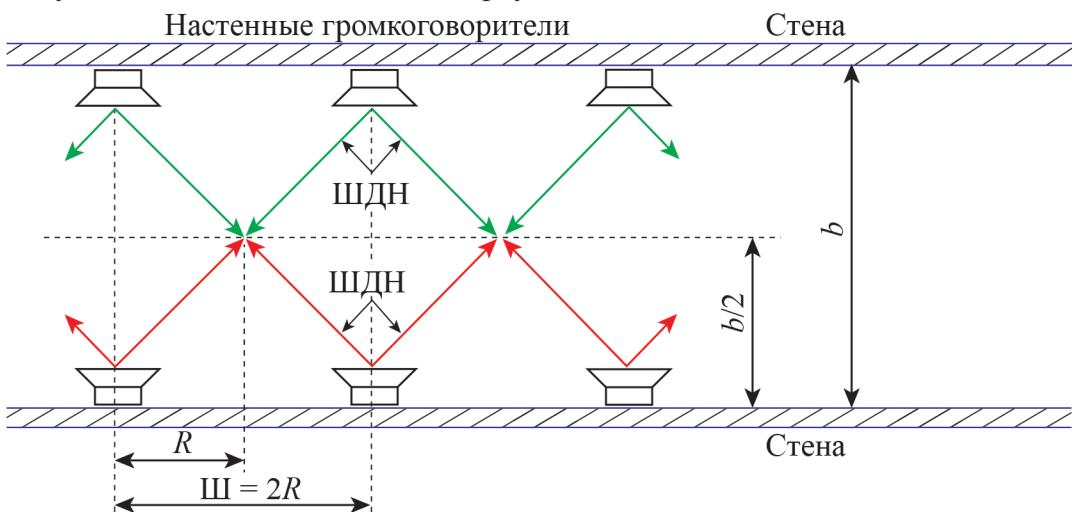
Расстановка настенных громкоговорителей в прямоугольных помещениях с размещением вдоль двух противоположных стен:
